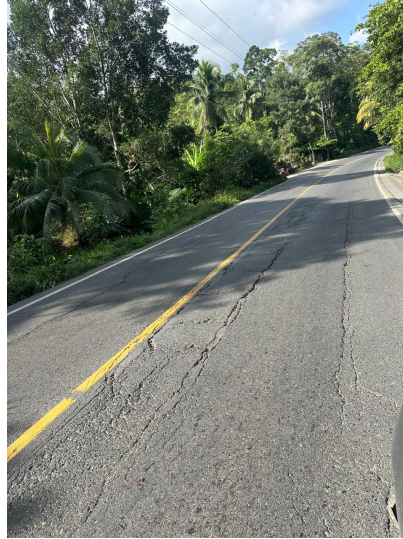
Grietas longitudinales (Km. 251 CA-13)
